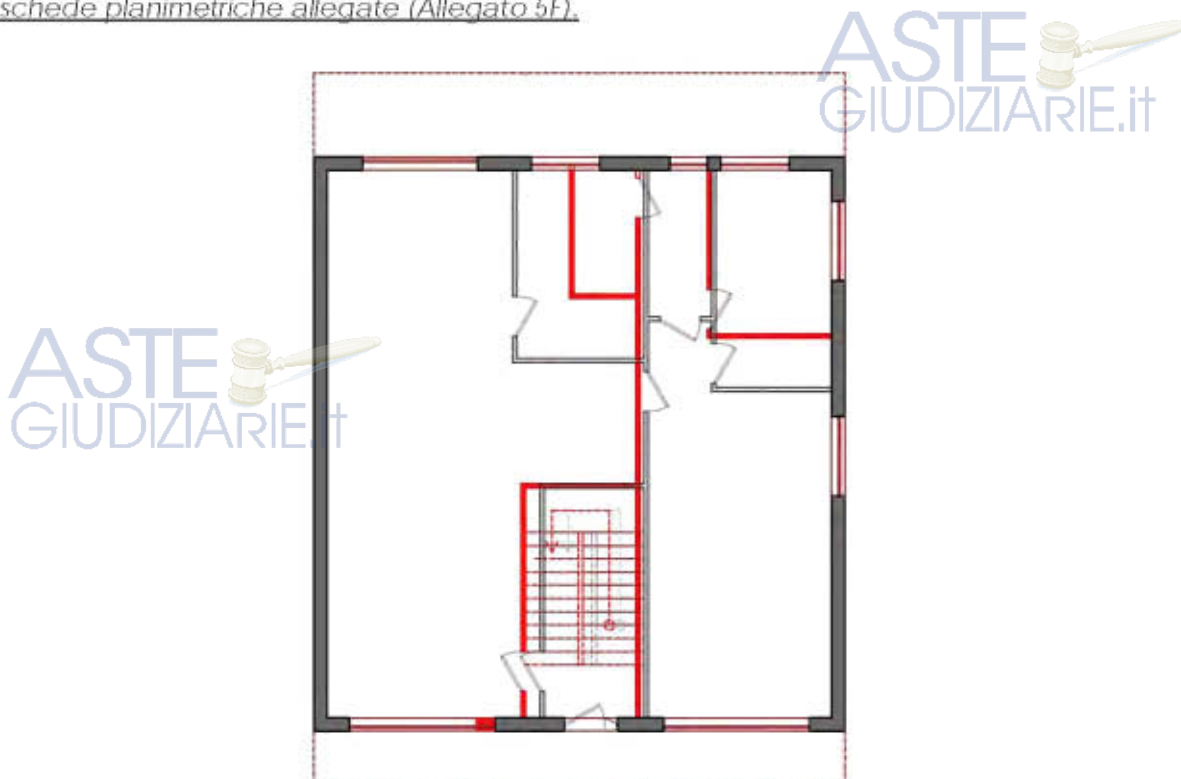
Sovrapposizione planimetria catastale (in rosso) su rilievo stato di fatto - Lotto Due e Lotto Tre
